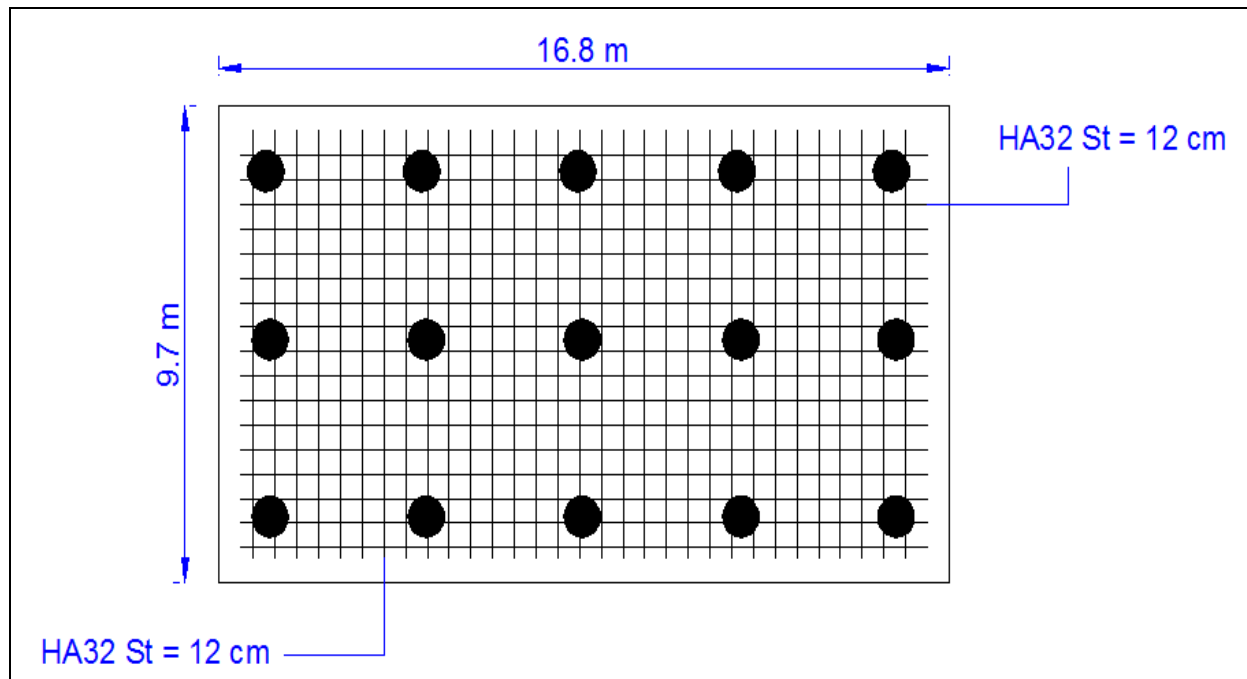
Schéma de ferrailage (nappe inférieure)
